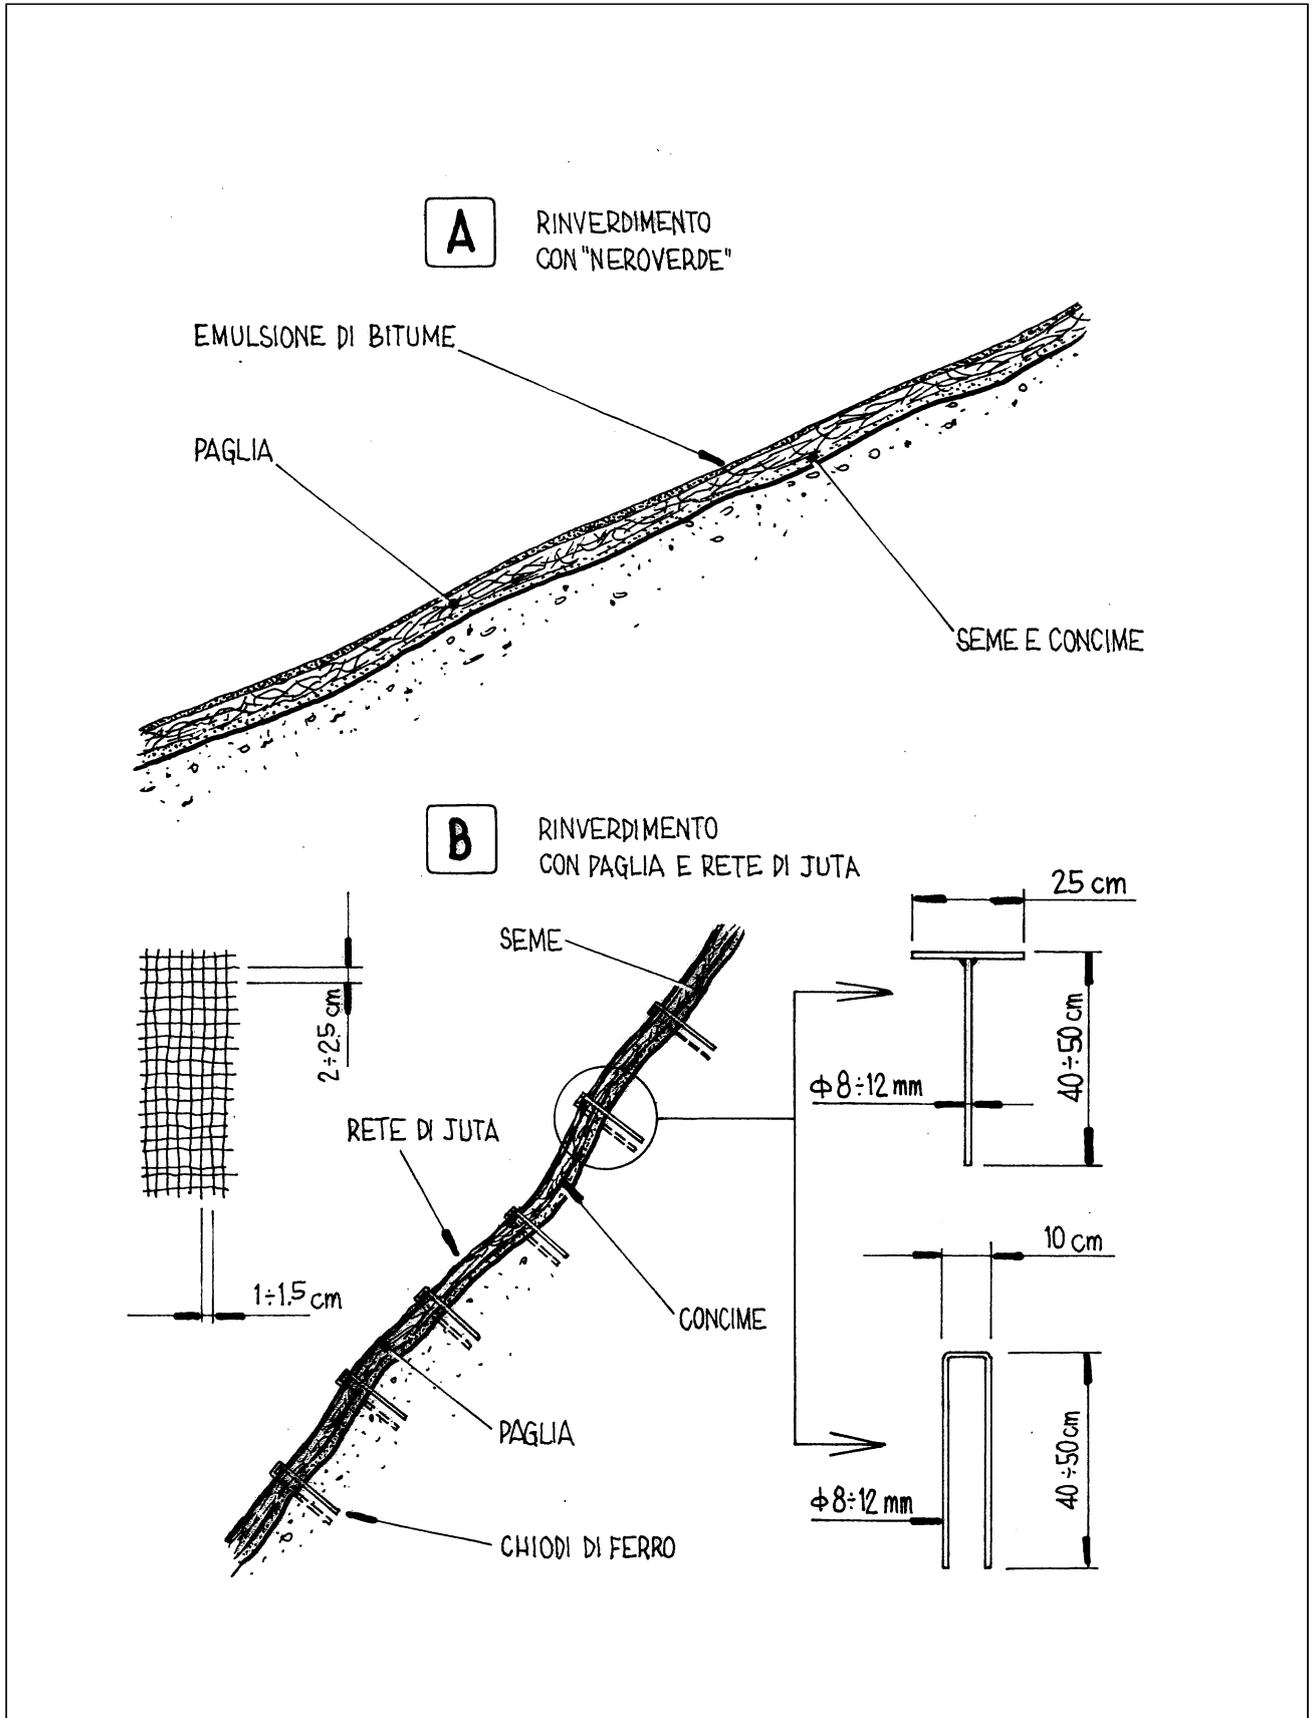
PROTEZIONE DI VERSANTI CON ELEMENTI ANTIEROSIVI E INERBIMENTO
